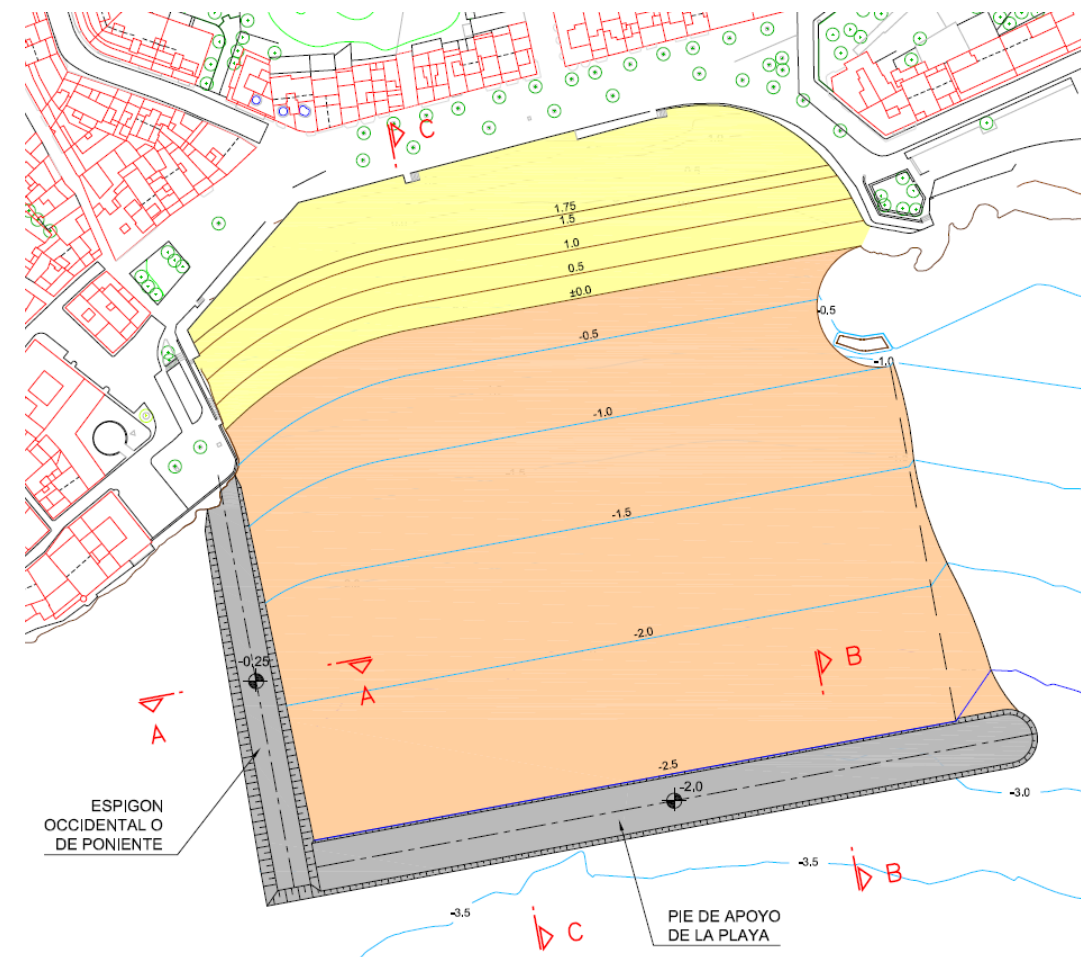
Planta de la Alternativa 3. (Fuente: Elaboración propia)
